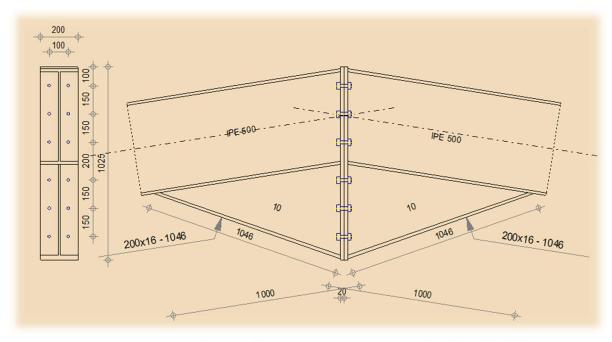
Détail d'assemblage poteau - traverse (IPE500-IPE500)
